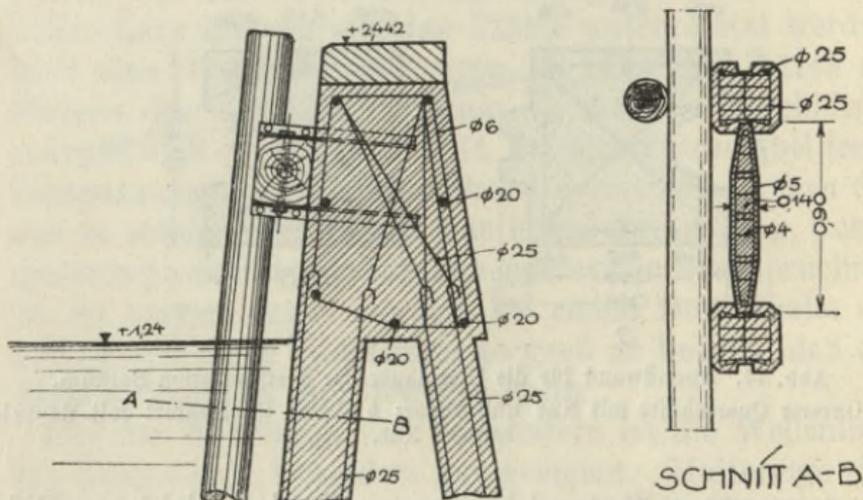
Querschnitt und wagerechter Schnitt der Eisenbetonkaimauer in Husum.
